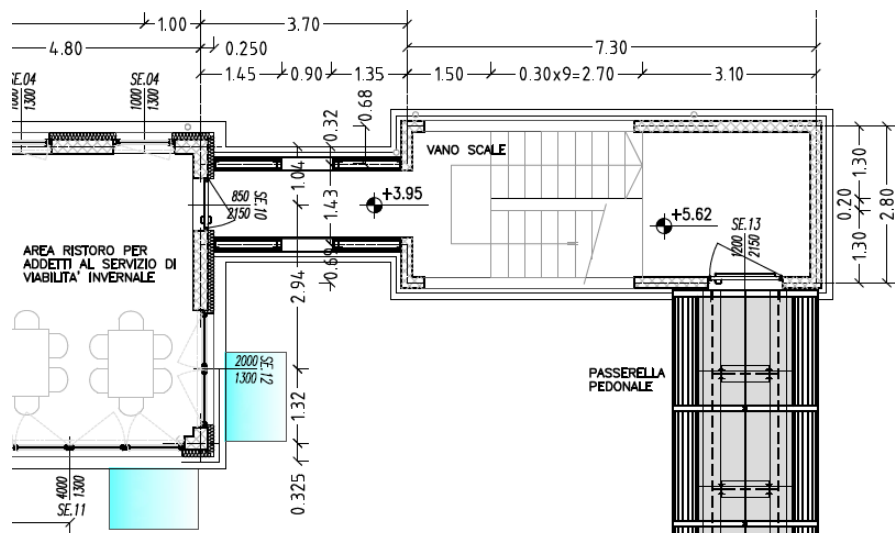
Pianta del primo piano del vano scale, con il collegamento alla passerella pedonale.
